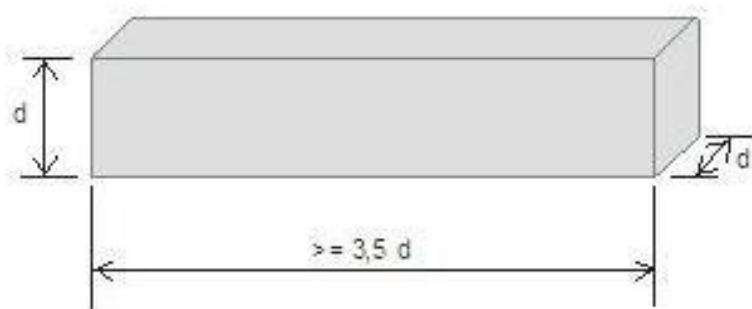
Dimensiones permisibles según norma ASTM C293 en vigas de concreto para pruebas de deflexión.
